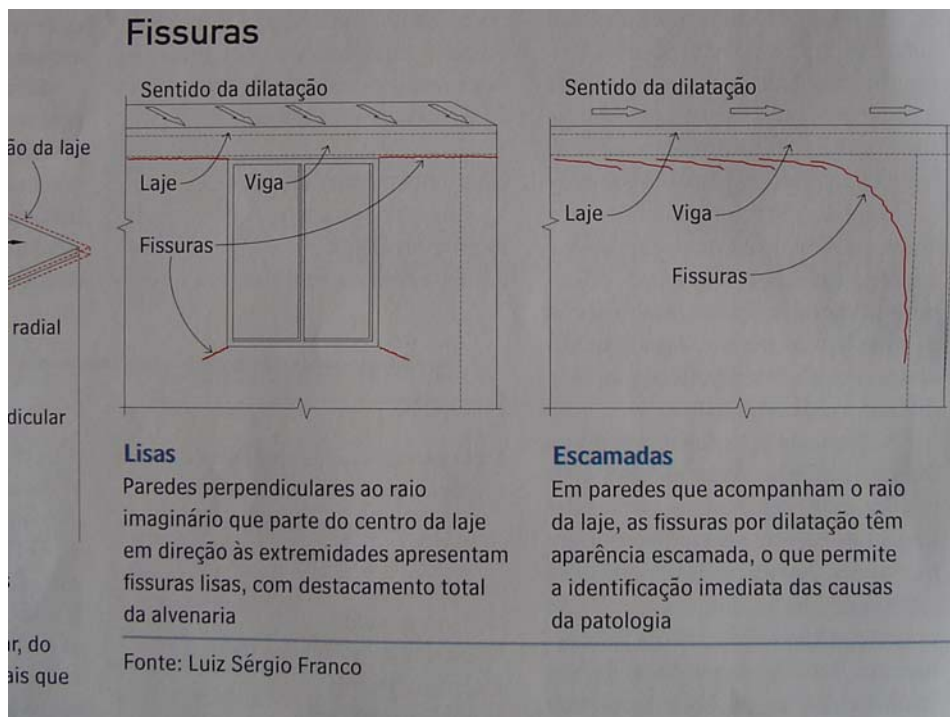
Fissuras por dilatação da laje de cobertura. (TÉCHNE 99, p.34)
